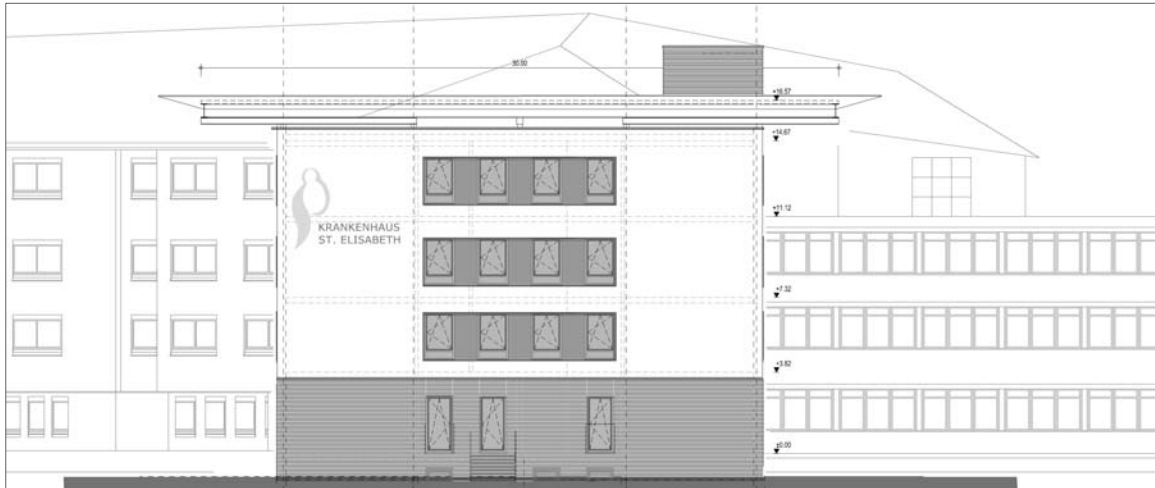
Ansicht West des geplanten Bettenhauses mit Dachlandeplatz /15/
